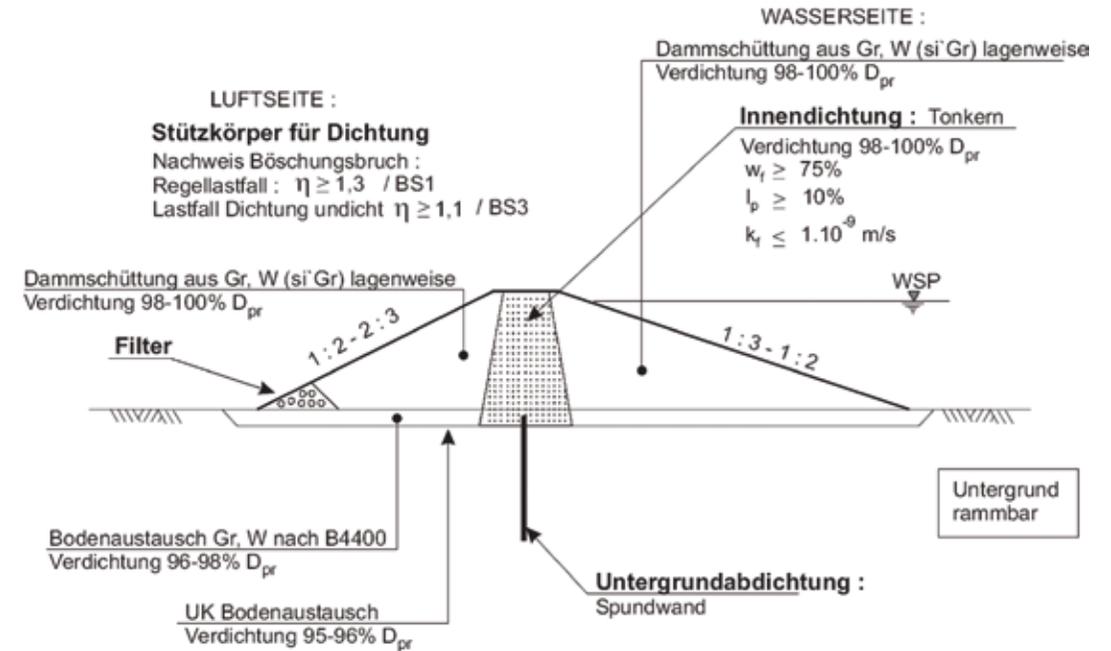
Bautyp – Damm mit Kernabdichtung, Untergrundabdichtung Spundwand
